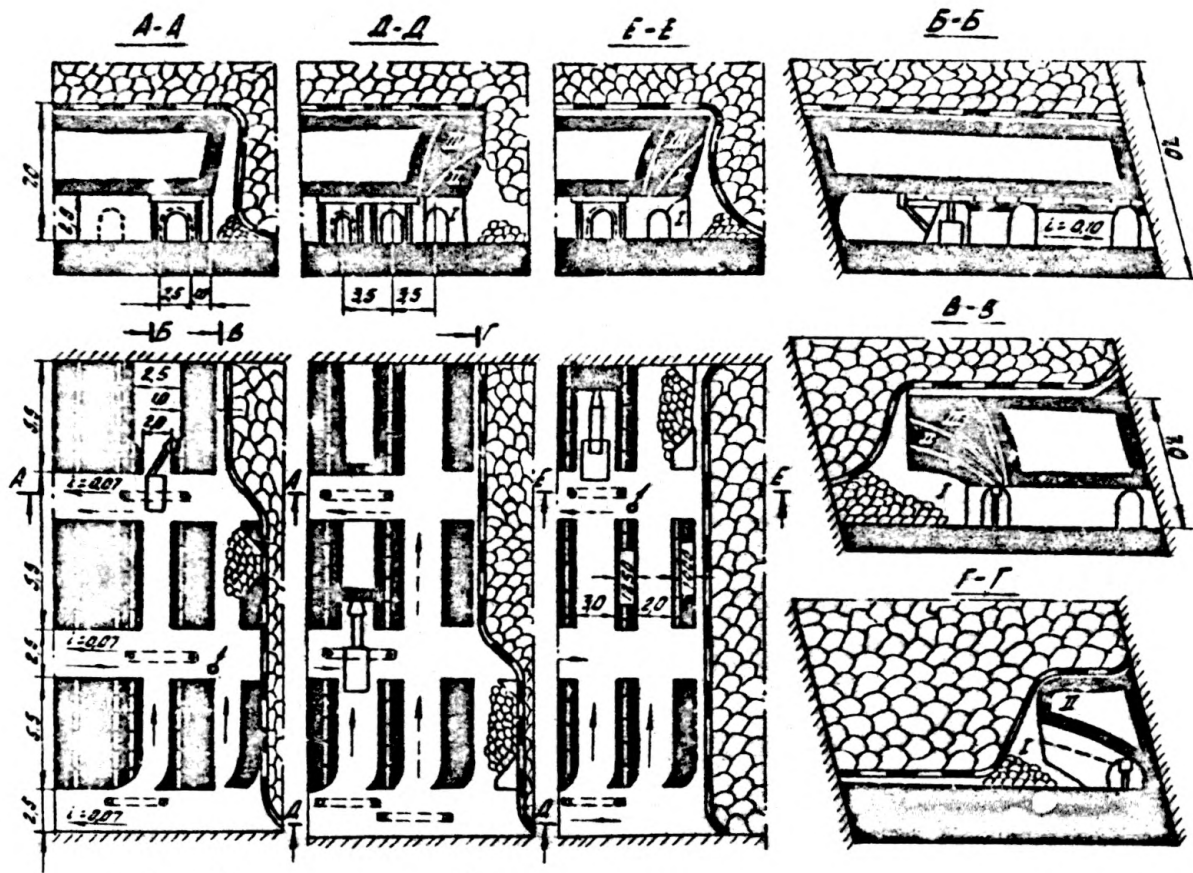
Схема отработки угольного массива под глубоким перекрытием полосами по восстанию с гидроотбойкой
